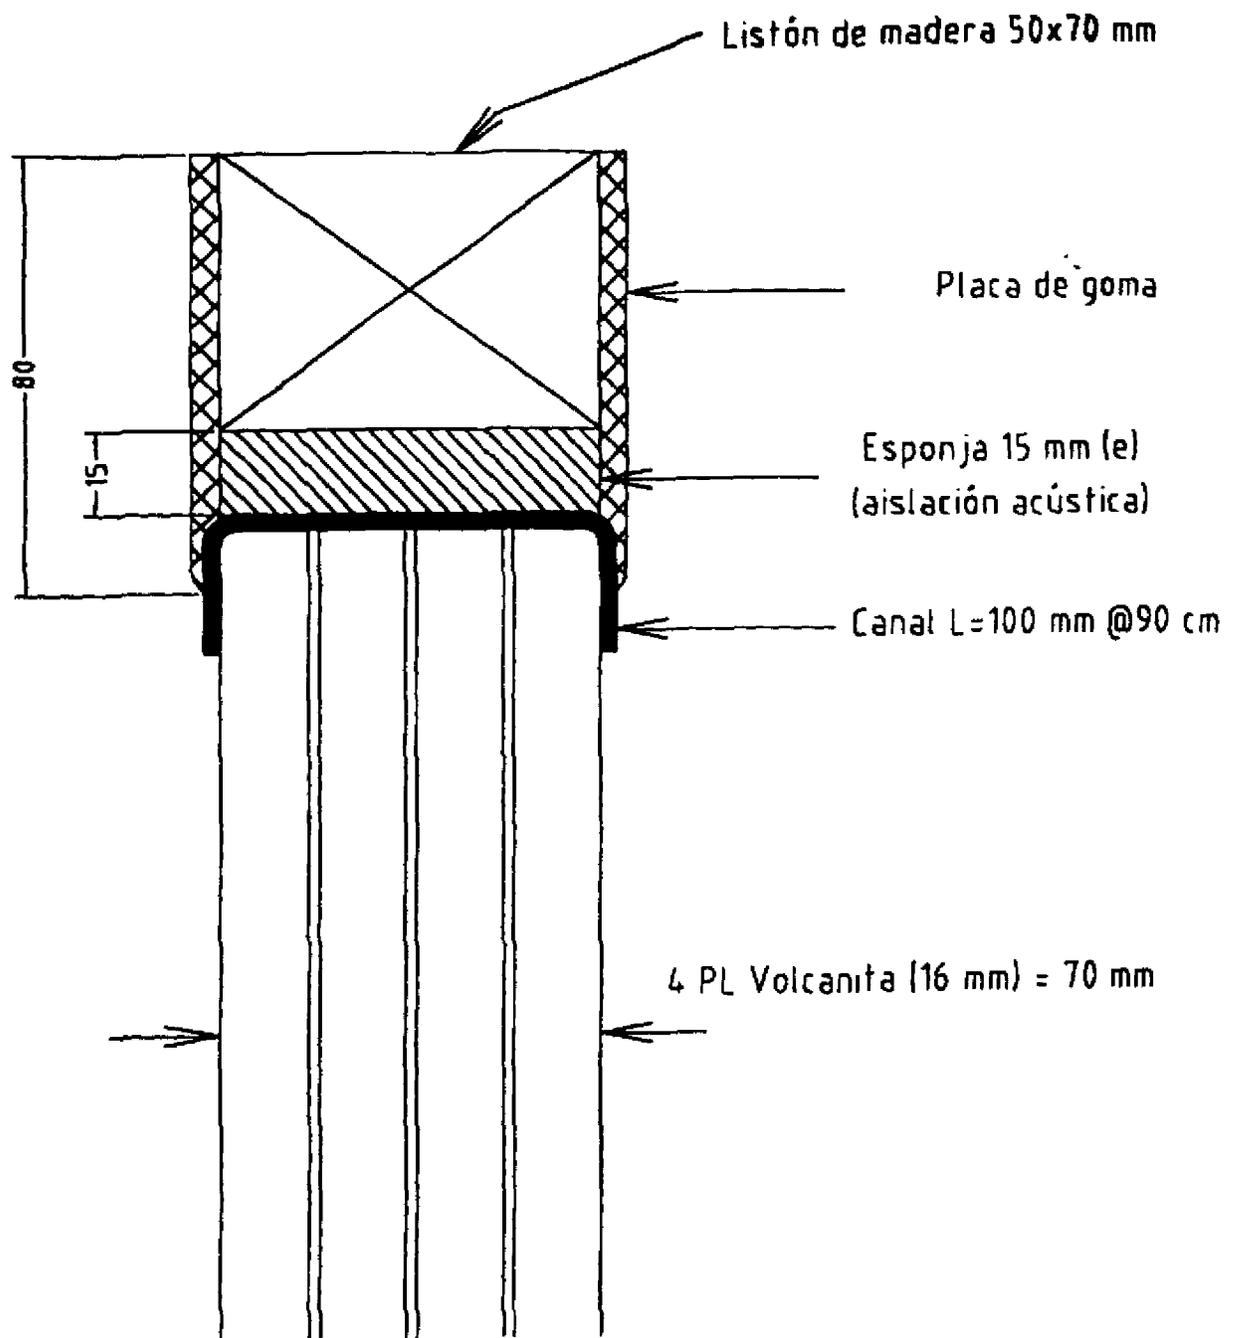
Detalle de apoyo lateral de la Tabiquería Tipo 2.
